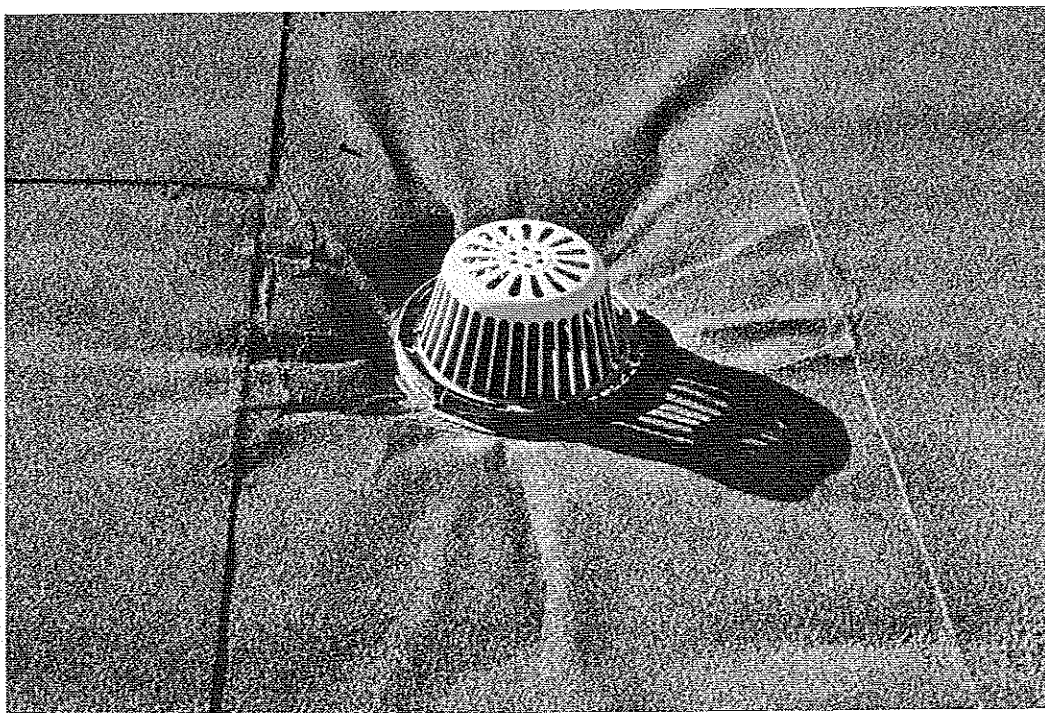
Entrées d'eaux pluviales en fonte d'aluminium (toiture au Québec). Difficultés de raccordement avec revêtement d'étanchéité. © J. Putatti
